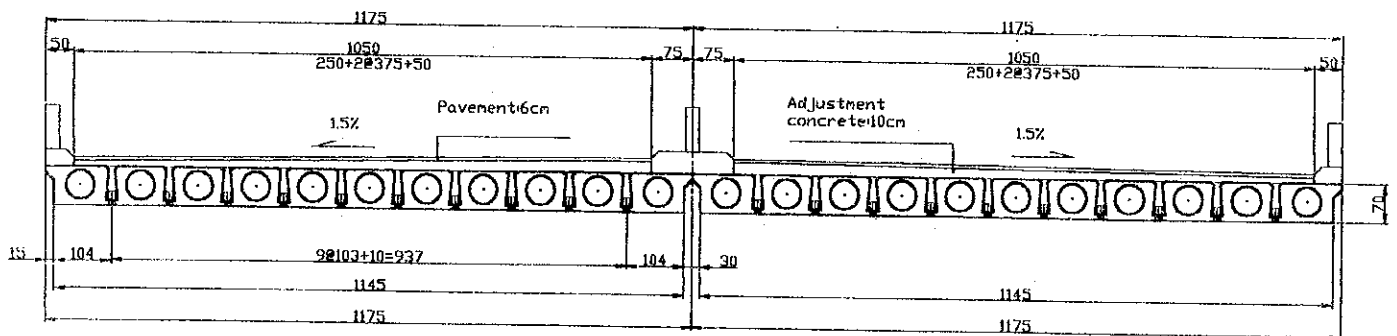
スパン $L_0=15m$: PCプレテン床版橋の標準断面図
